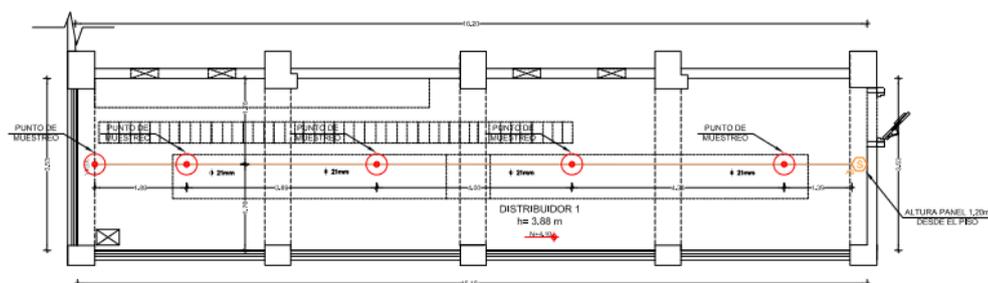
Plano de ubicación de módulo de detección FAAST, recorridos de tuberías y puntos de muestreo de sala de Distribuidor 1
